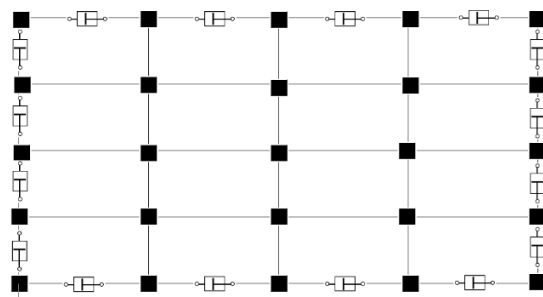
Ejemplo de distribución de aisladores RB bajo pilares y los amortiguadores en el perímetro de la estructura.
